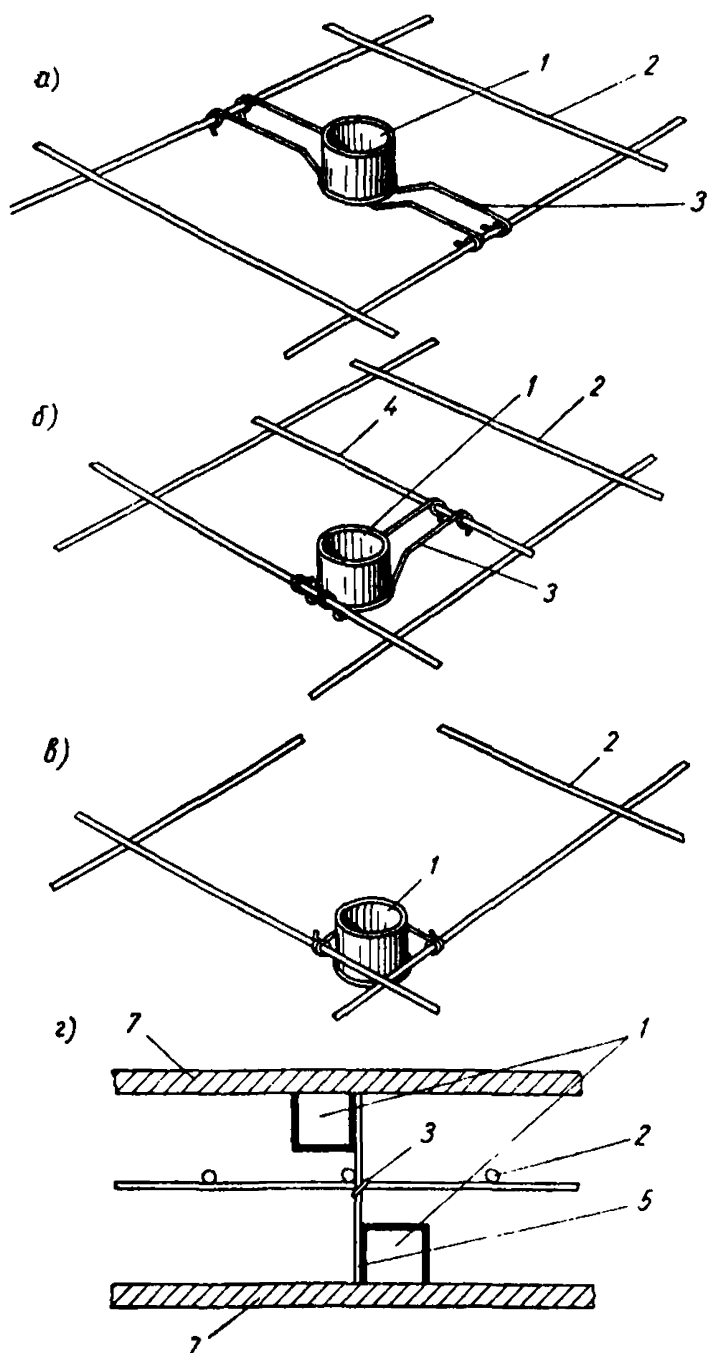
Закрепление соединительных коробок на арматурном каркасе железобетонных панелей
